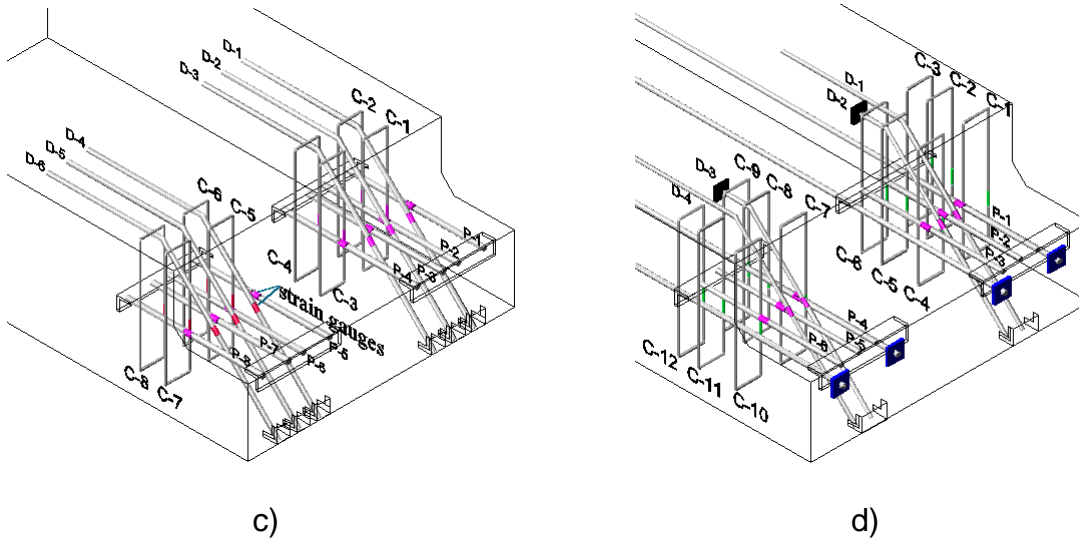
(continuación) Configuración del armado de extremos recortados y su instrumentación: a) espécimen E1, b) espécimen E2, c) espécimen E3 y d) espécimen E4
